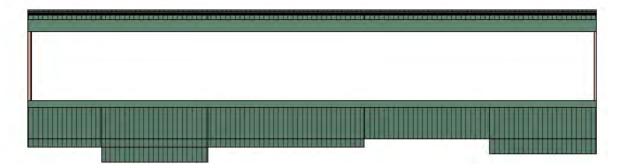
Darstellung des Dachaufbaus in der Grundrissansicht.
